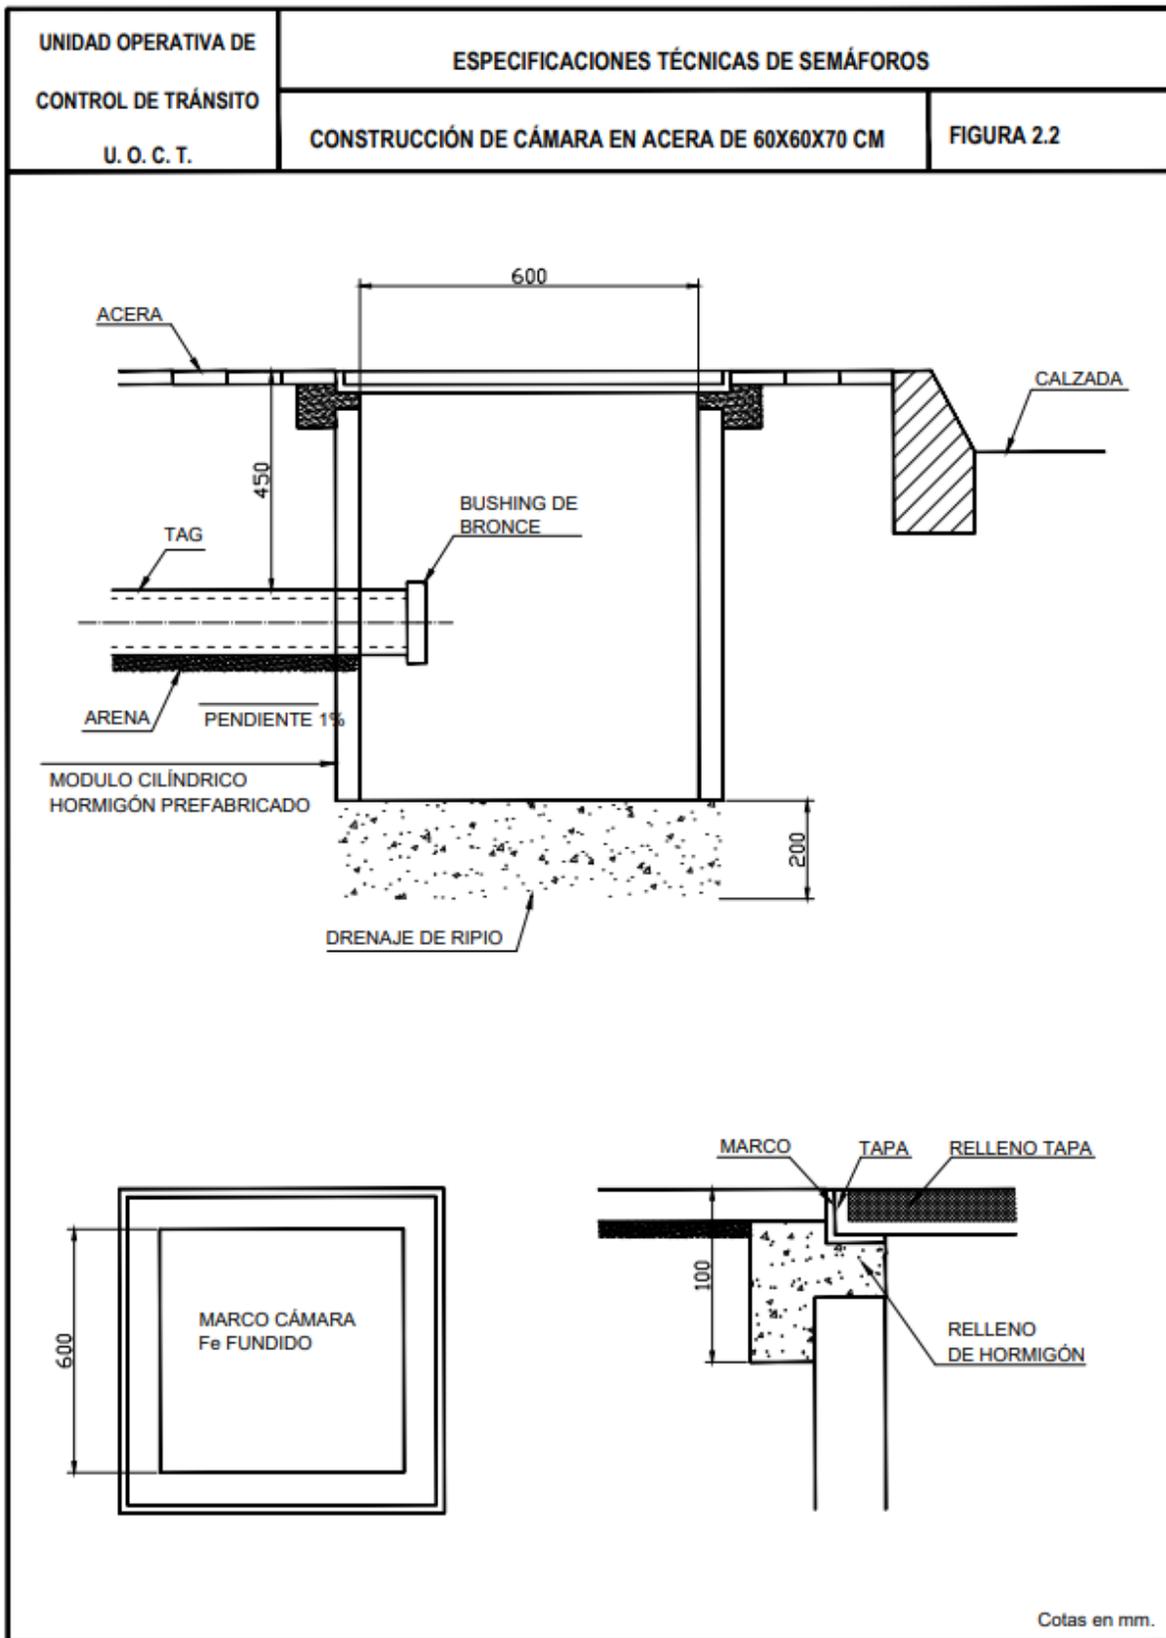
2 Construcción de cámara en acera de 60x60x70 cm
